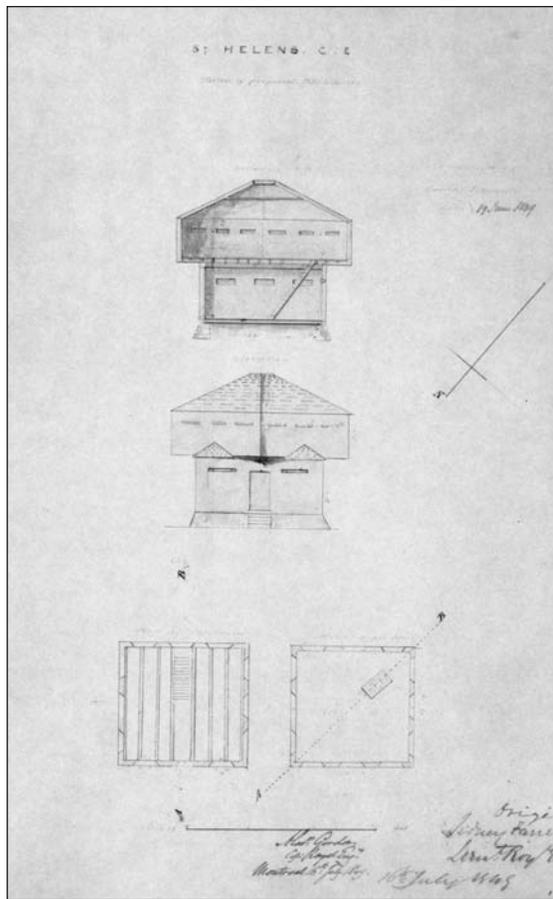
Le plan ayant servi à la construction du blockhaus en 1849. Public Record Office de Londres, St. Helen's C. E. Sketch of proposed Blockhaus, 19 juin 1849, MPH 807/8, W0 1/560, f.245
